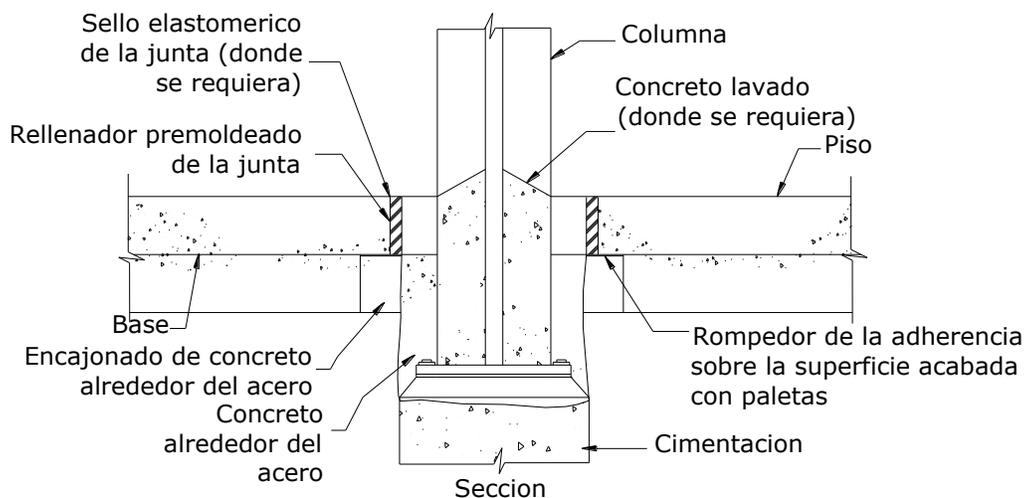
a - Juntas de aislamiento en columnas (vista de corte)
